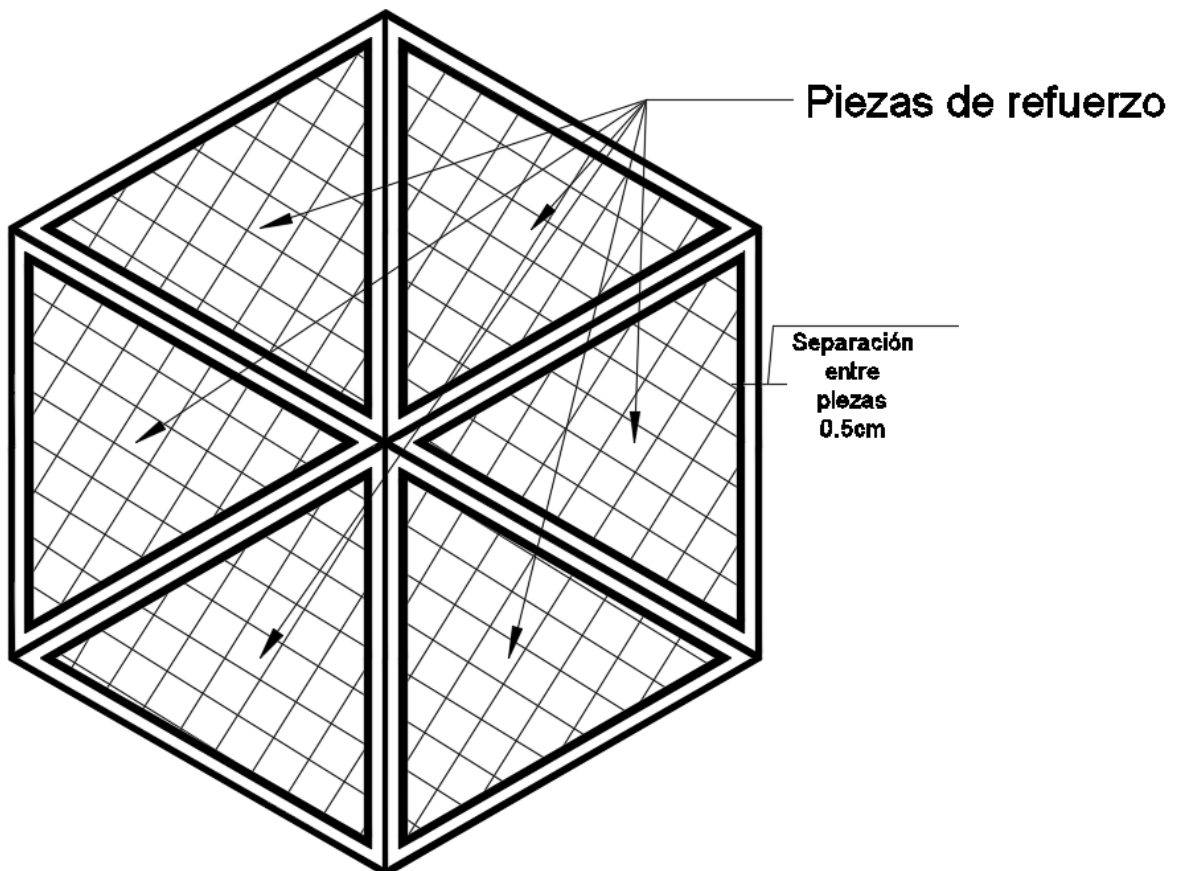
Diseño de las piezas de refuerzo. Vista en planta.
